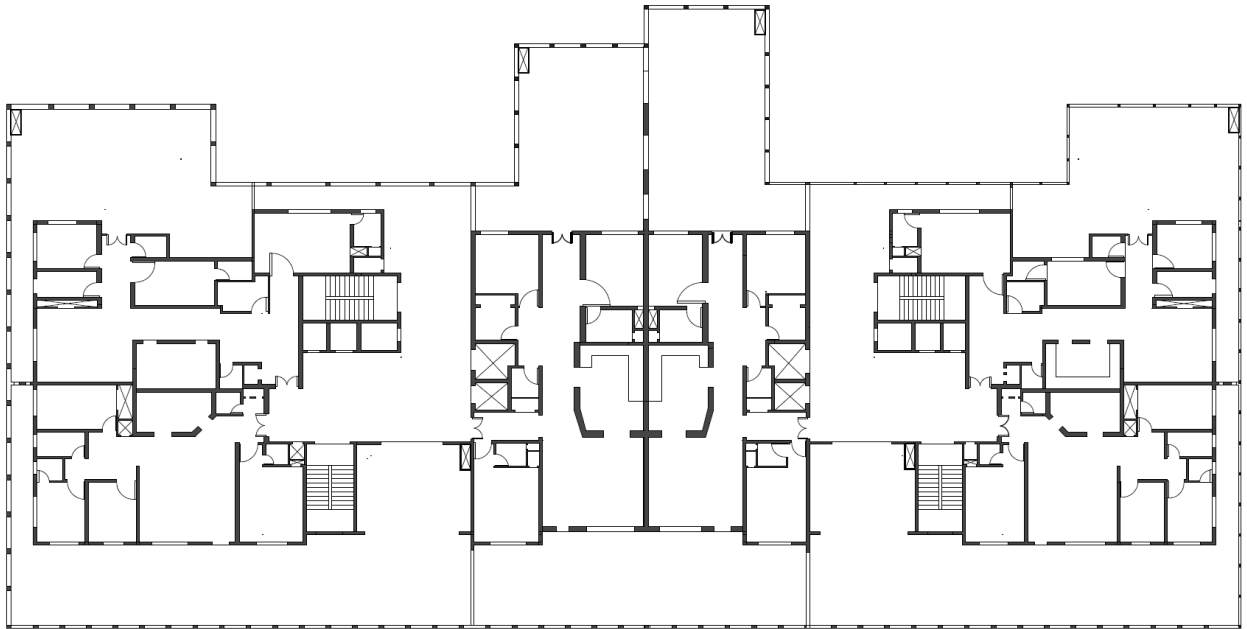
Ж: показан типовой план верхних этажей.
